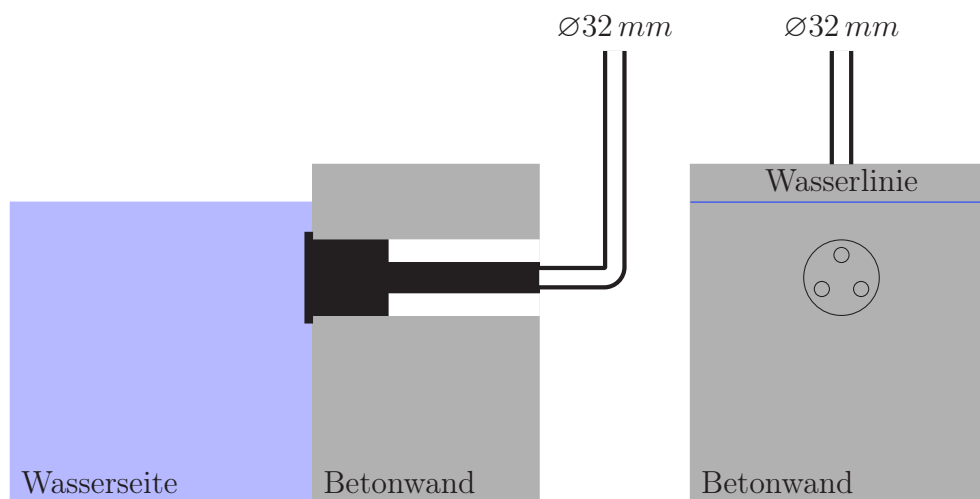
Skizze Einbau PIEZO Tri in Beckenwand. Links: Schnitt durch den Piezo-Schalter. Rechts: Frontansicht auf den Piezo-Schalter. Die Maße der Einbauteile entnehmen Sie bitte der Zeichnung im Anhang (ab Seite 42).
